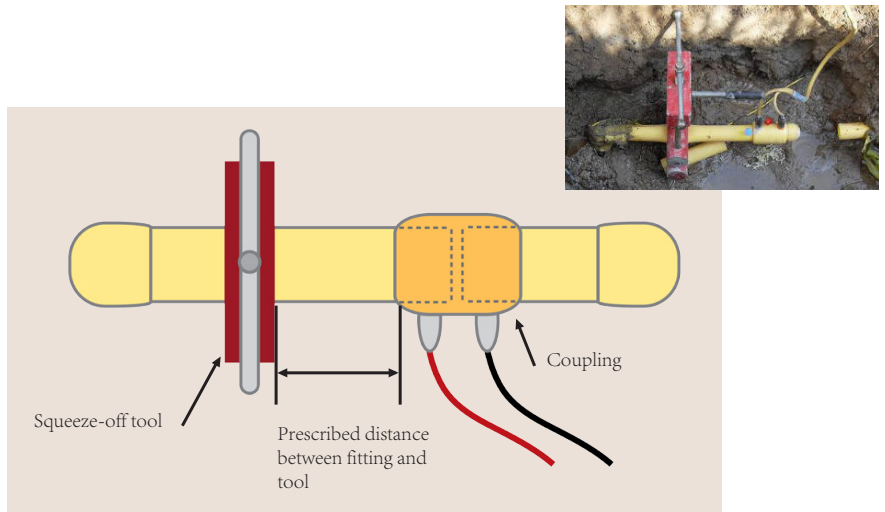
正进行压扁阻断的聚乙烯天然气管道。图注：Squeeze-off tool - 挤压工具；Prescribed distance between fitting and tool - 装置与工具间的规定距离；Coupling - 连接处
